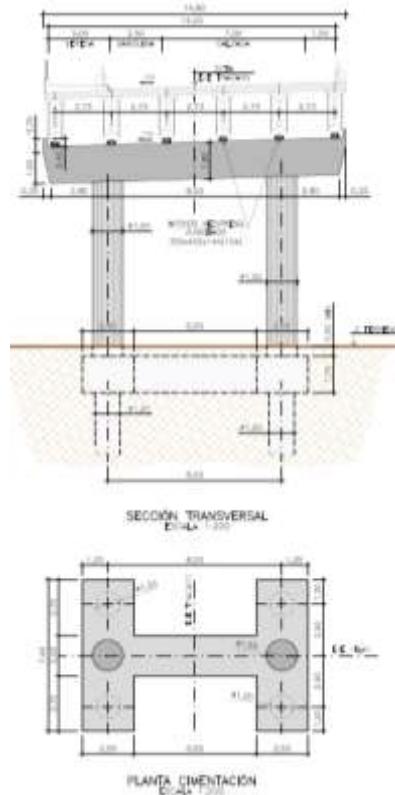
Pila pórtico de 2 fustes para apoyo de tablero de calzada sencilla.
